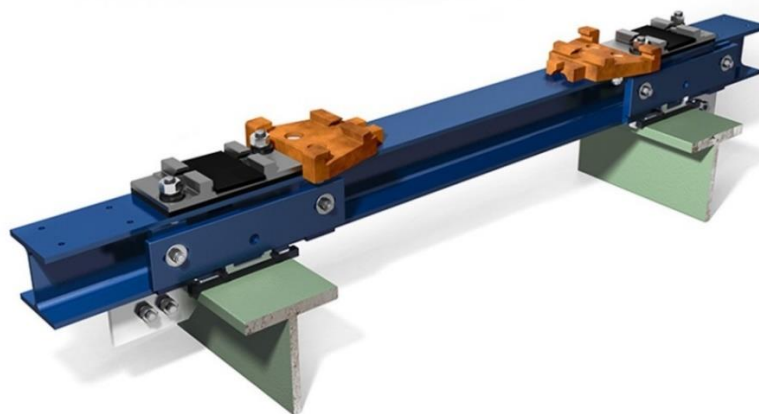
Конструкция мостового полотна на металлических поперечинах SBS.
